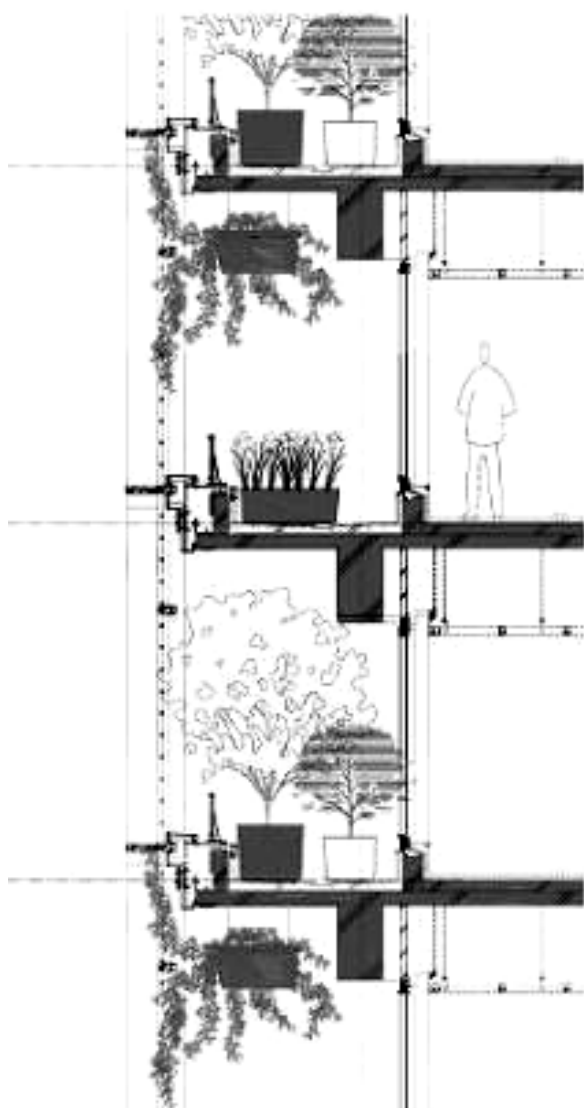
Двойной «живой» фасад. Фрагмент разреза здания [3]
